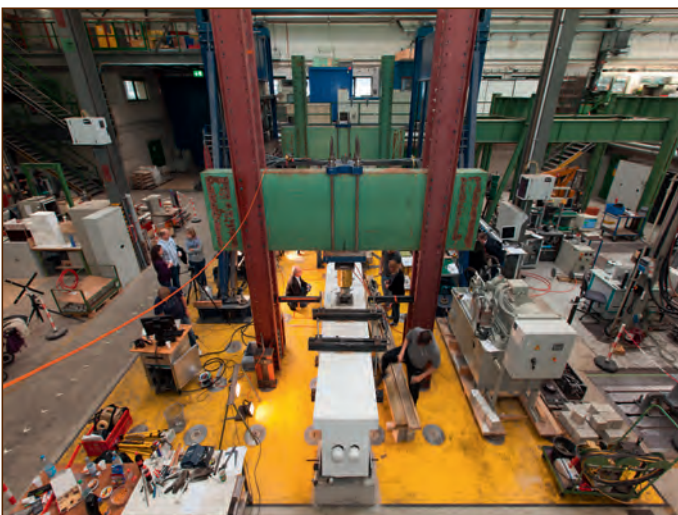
Messungen an vorgespannten Betonträgern, Versuchsaufbau des Lehrstuhls Betonbau (Prof. Reinhard Maurer), Foto: Detlef Podehl
